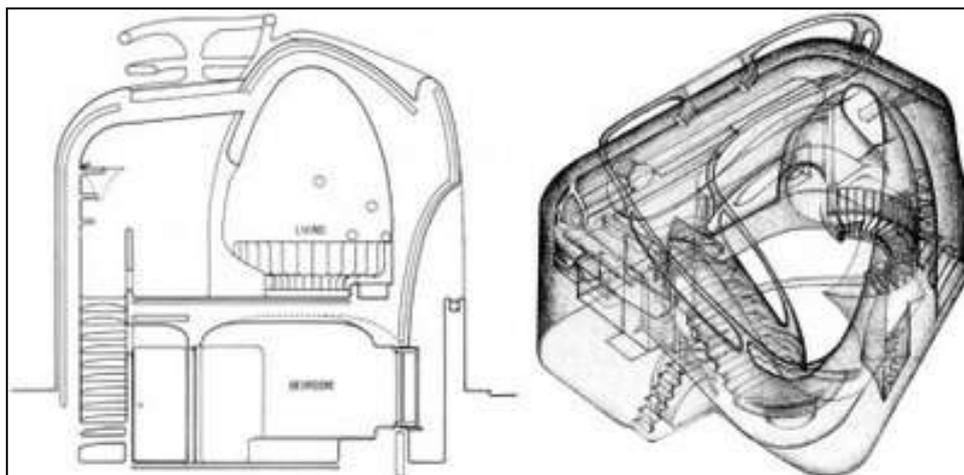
Corte e perspectiva esquemática da Truss Wall House
